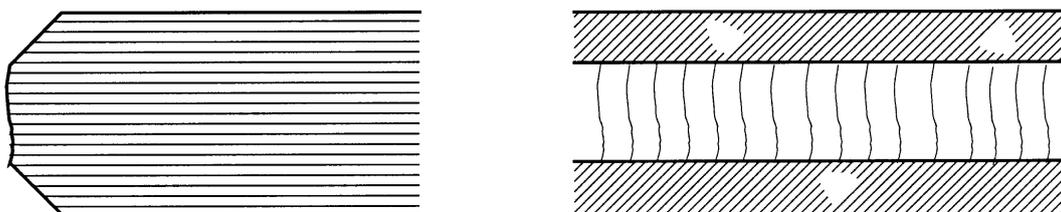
Gesäumte Kante (mit blanken Stellen)
